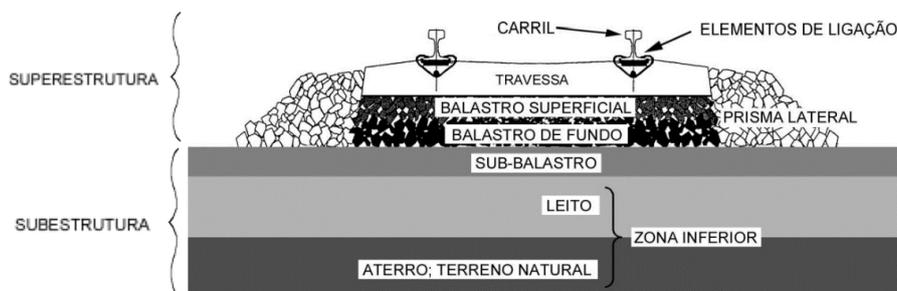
Esquema estrutural da via balastrada (adaptado FERNAVE, 2003)
